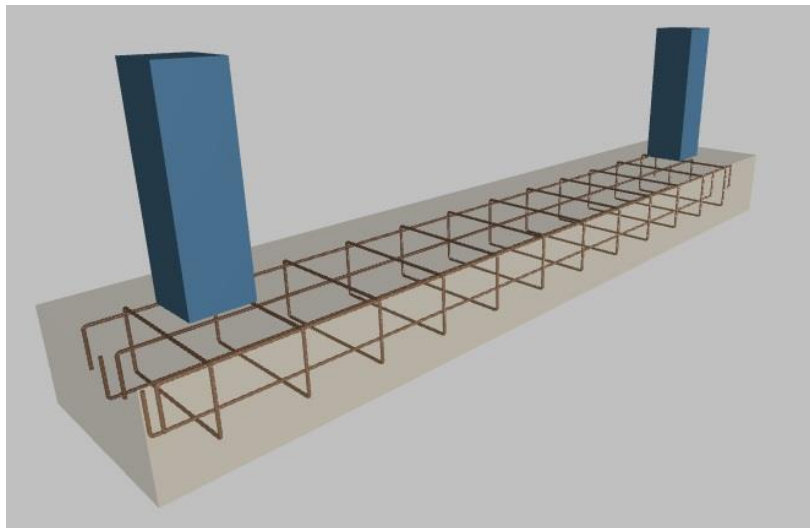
Vista 3D de la cimentación. Fuente: autor
